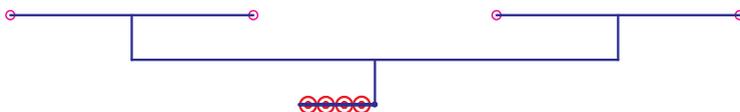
Пример разводки на 4 насадка в помещении вытянутой формы
